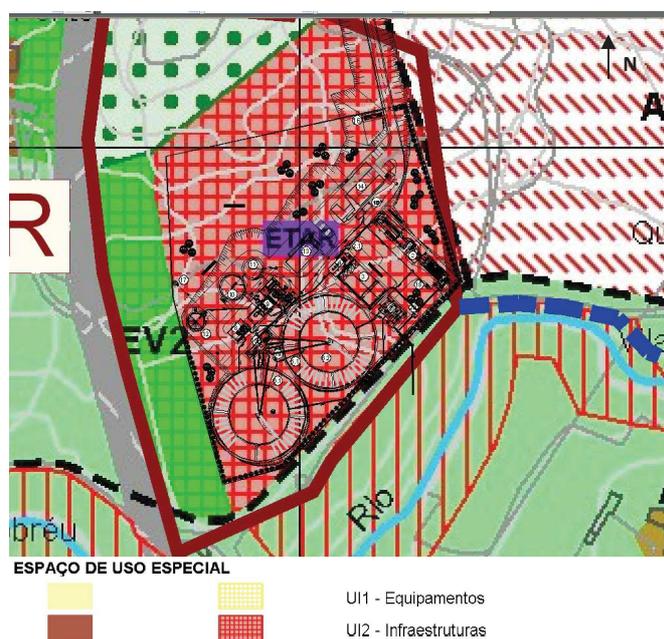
Extracto da planta de ordenamento com a implantação da ETAR
